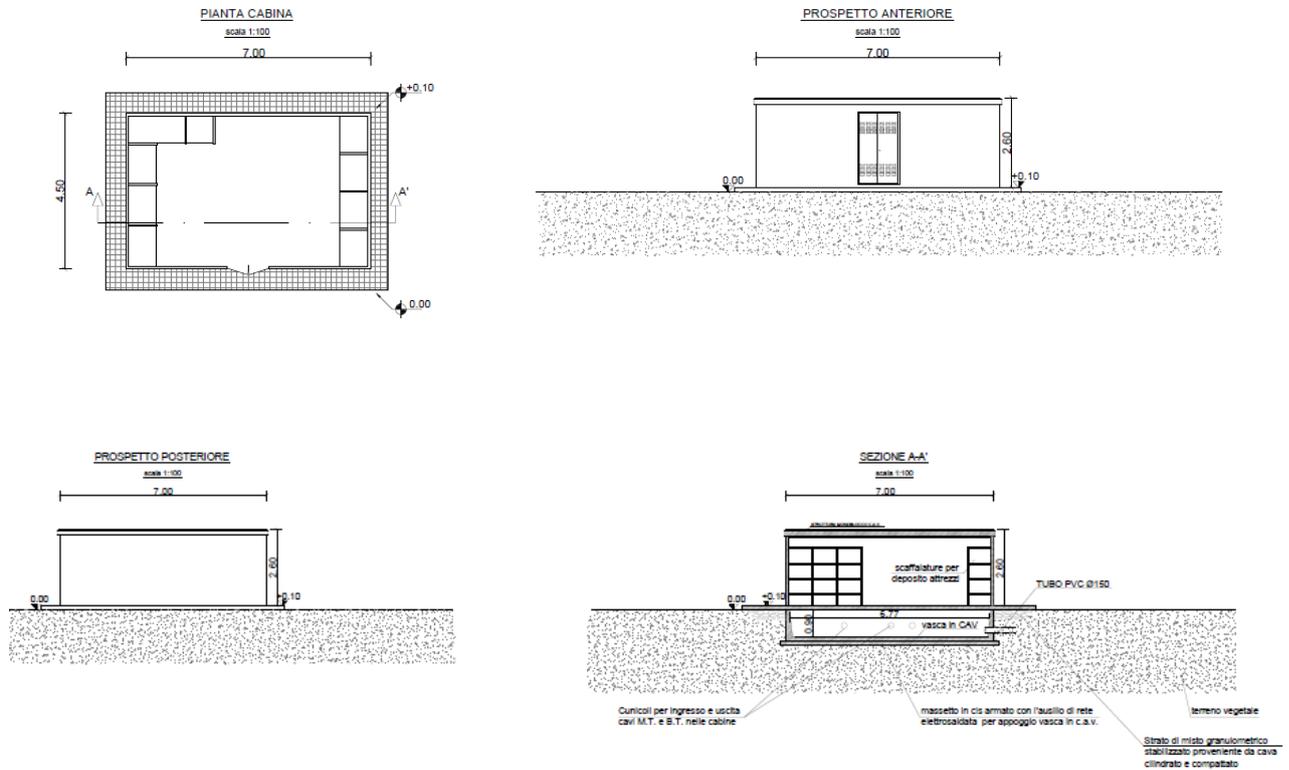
Pianta e sezione della cabina di manutenzione e ausiliaria
